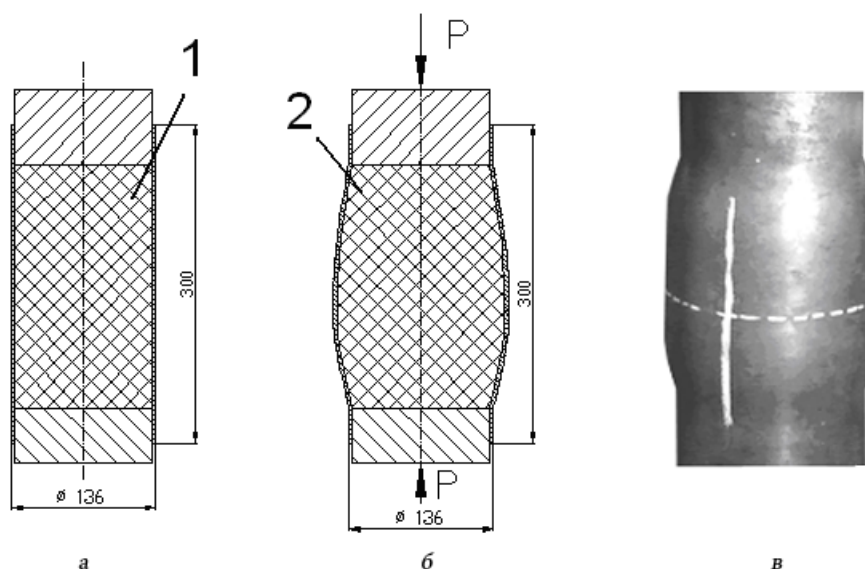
Оболочечный образец из стали 05кп (а) и схема его нагружения (б);
